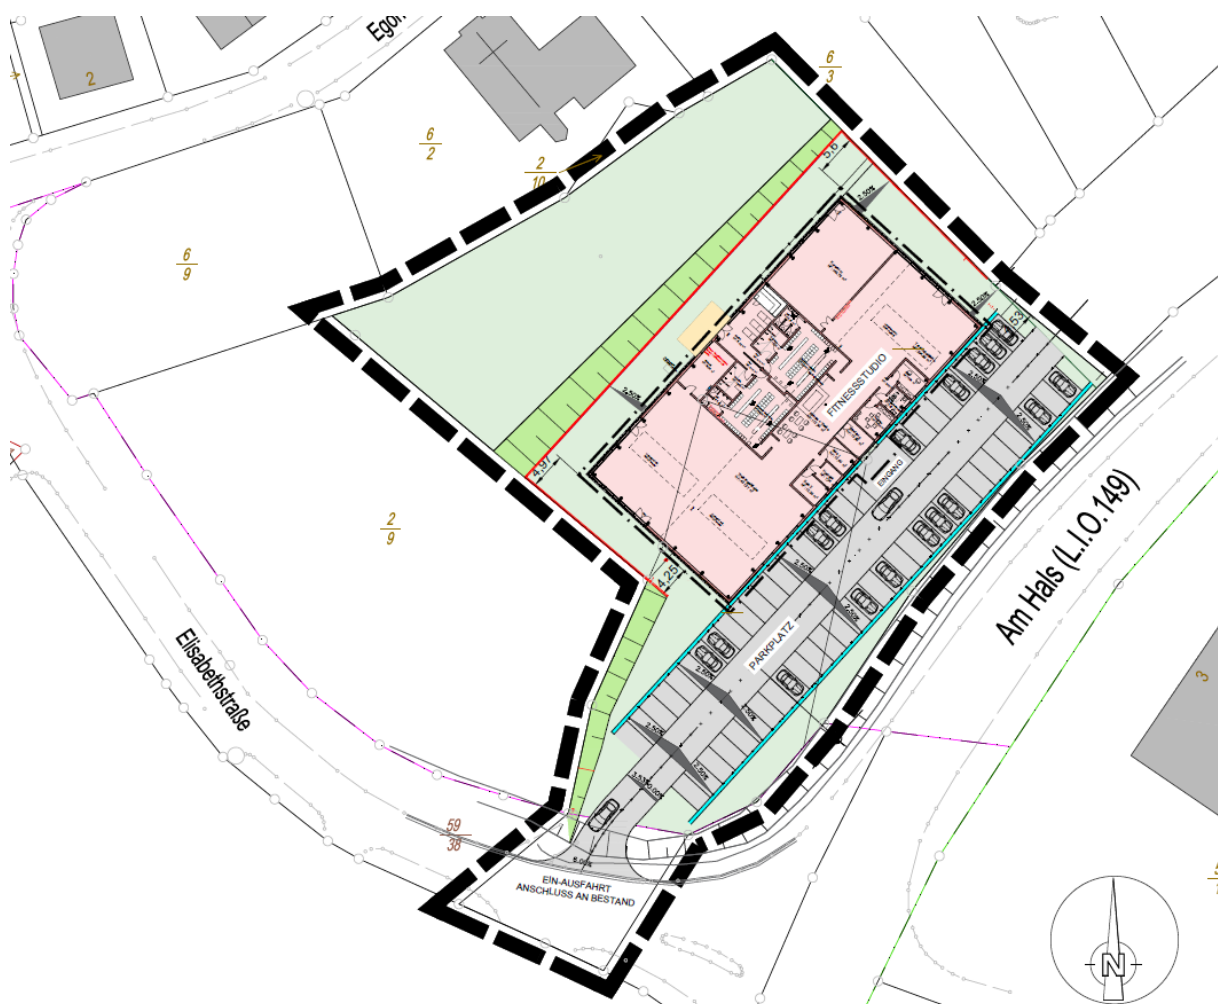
Vorhaben- und Erschließungsplan „Fitnessstudio“ in der Elisabethstraße, Lageplan, o.M. (Quelle: IBA Krämer, Saarburg).
